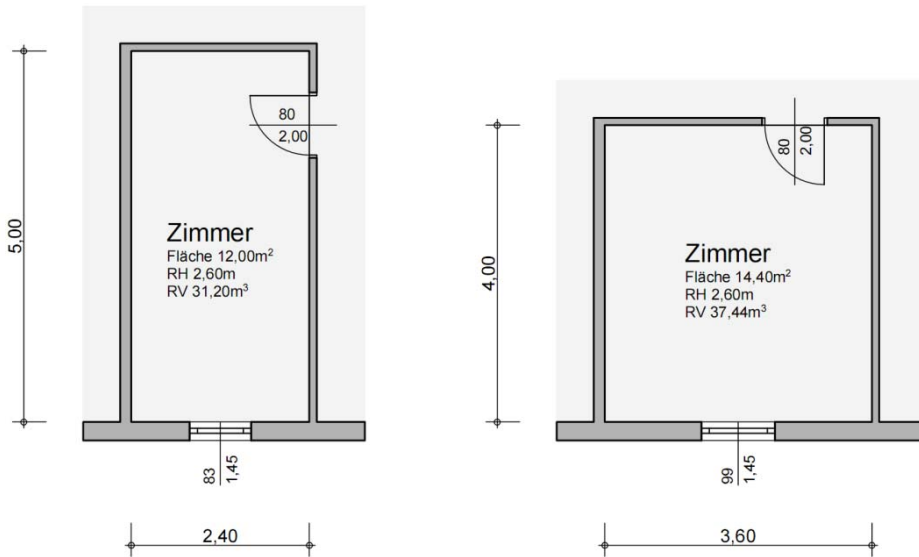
Grundrisse Zimmer 12,00m² und 14,40m²
